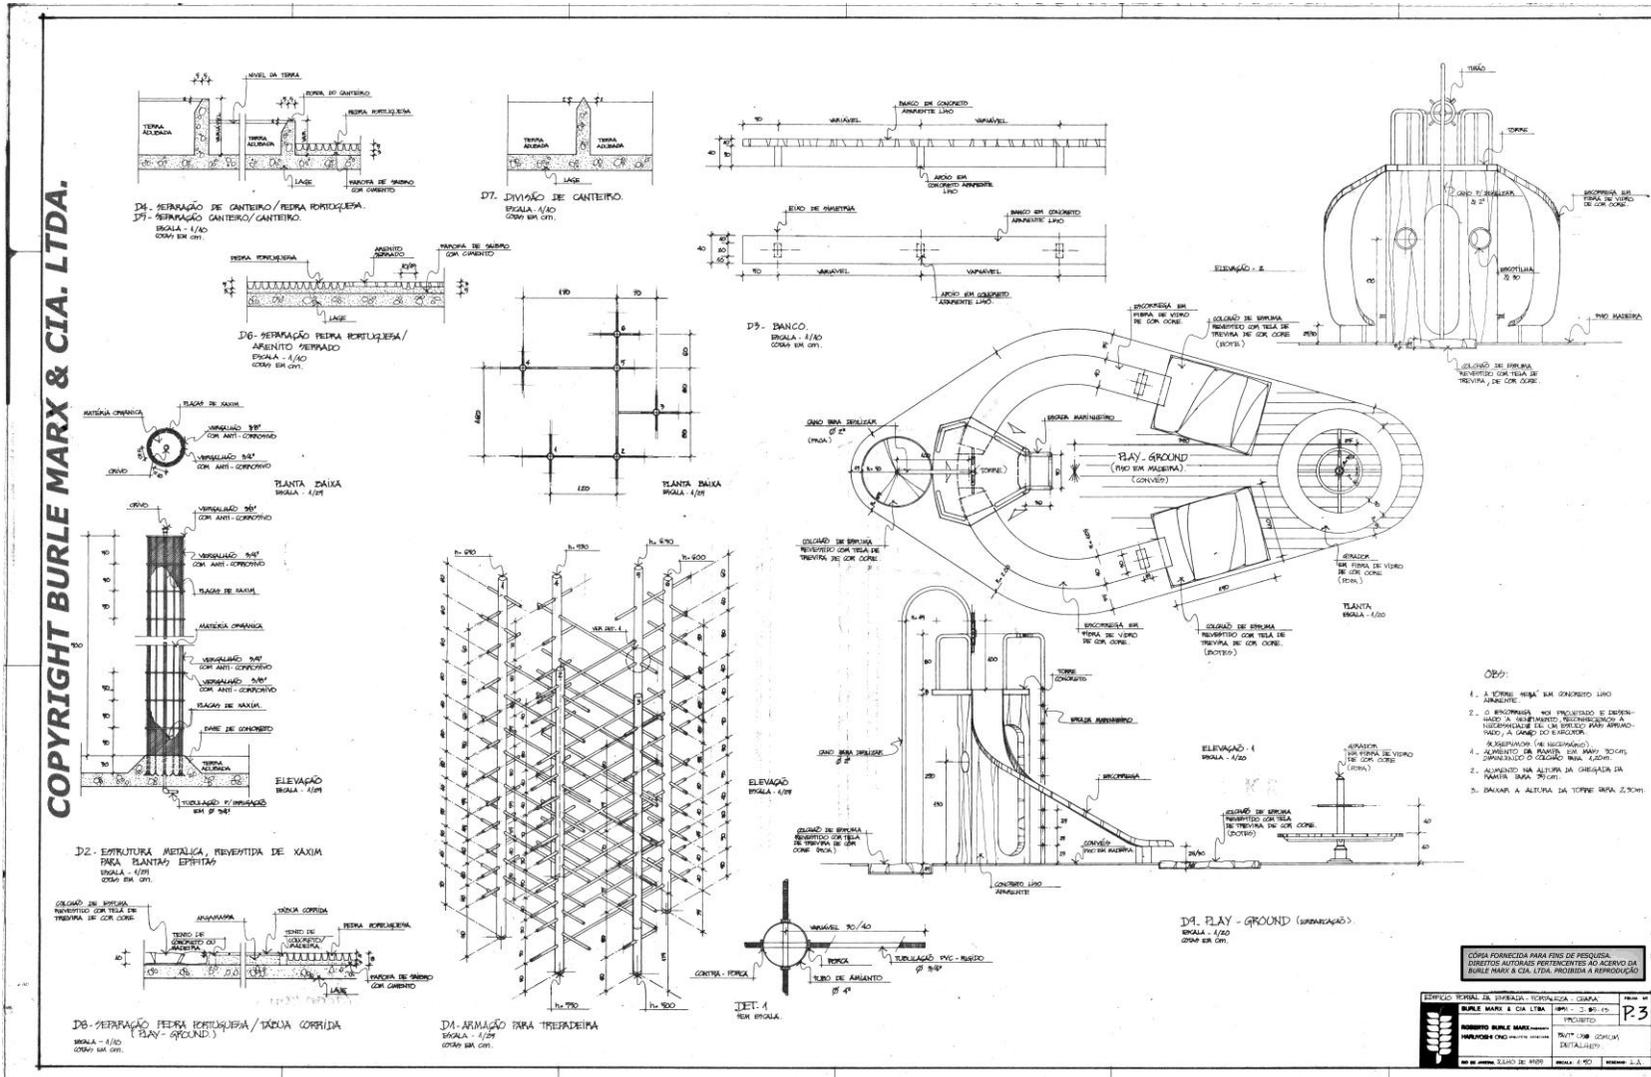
DETALHAMENTO BRINQUEDOS E ESCULTURAS DE PLANTAS
